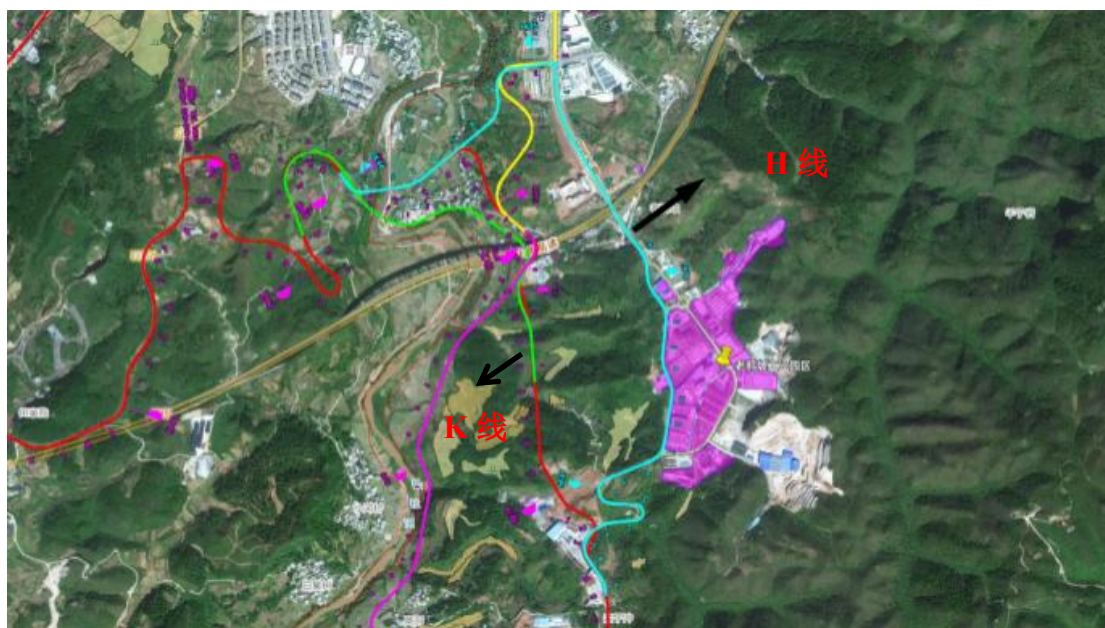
毛头脚至麦子冲段方案比选平面图
